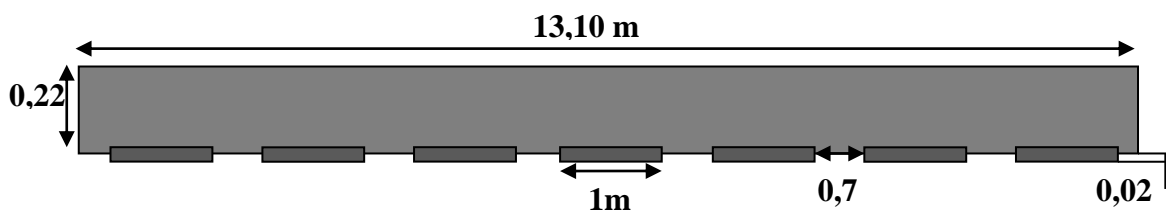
Coupe transversale de la dalle + pré dalle
